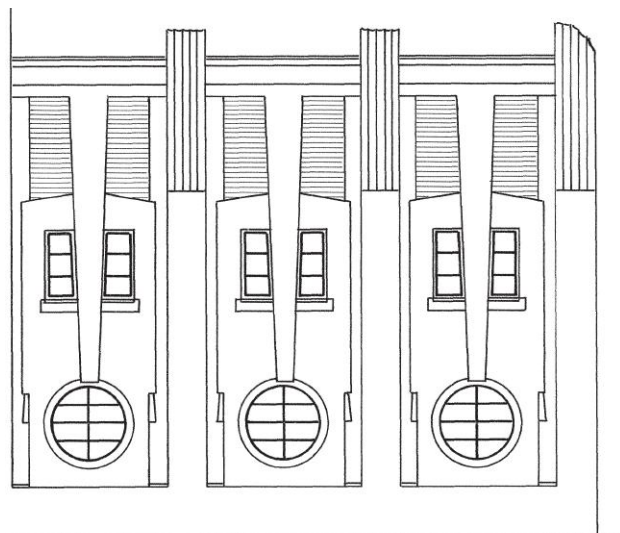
Elevation de la façade Nord du massif - deuxième cas
